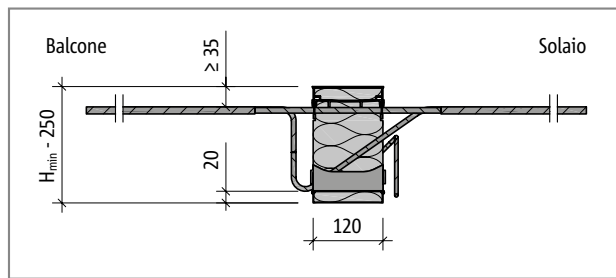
Schöck Isokorb® tipo KXT55 – KXT100: sezione dell'elemento
